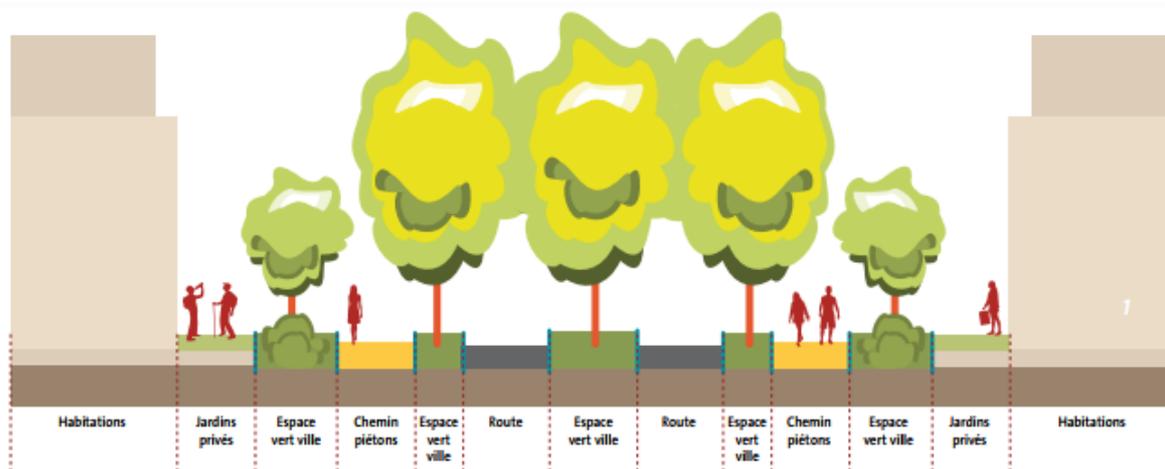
Coupe d'une voie dans la ZAC des Champs Bleus
